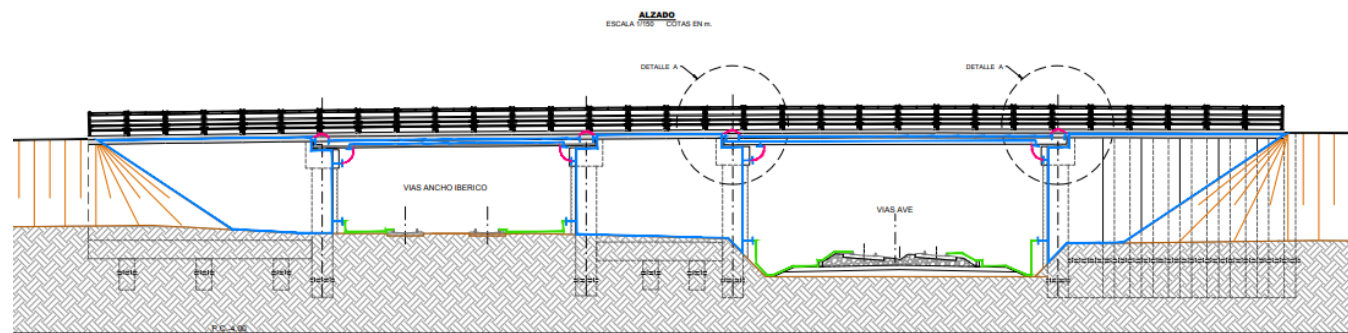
Alzado estructuras sobre ferrocarril y AVE
